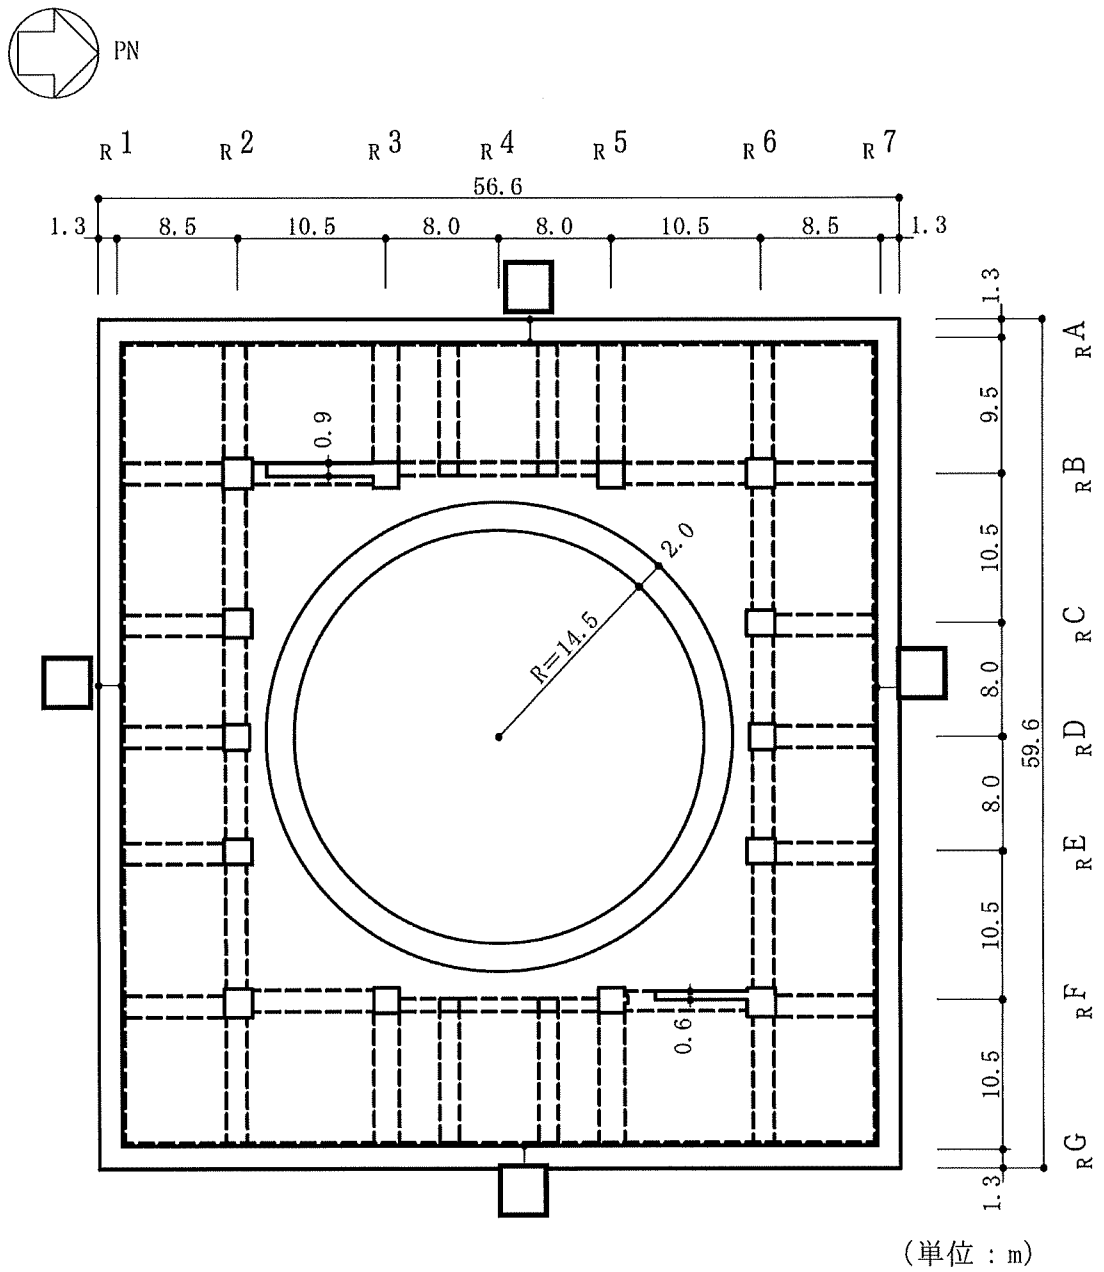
原子炉建屋の概略平面図 (B2F, T. M. S. L. -1.7m) (2/9)
